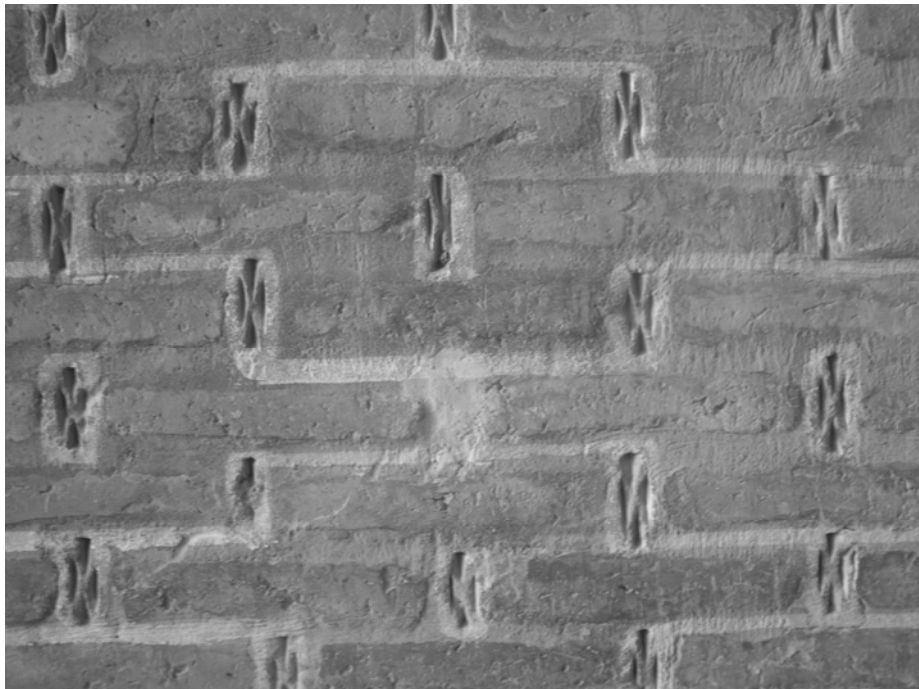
Masjed-e Jāme' di Sin: *gonbadkhāne*, particolare te ssitura muraria (foto dell'autore. Settembre 2008)
